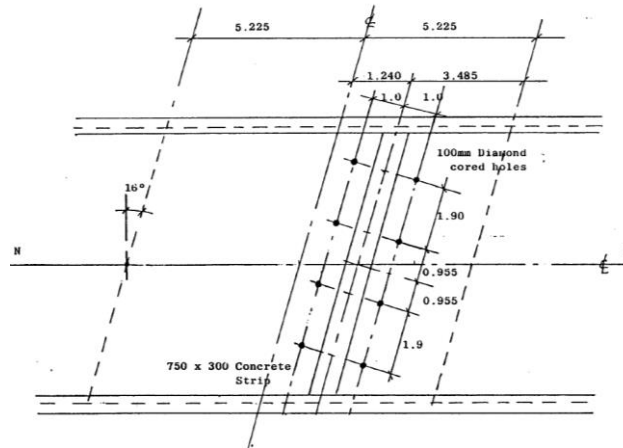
Bargower Bridge: planimetria con indicazione dell'area caricata e degli ancoraggi dei martinetti idraulici. [54]
